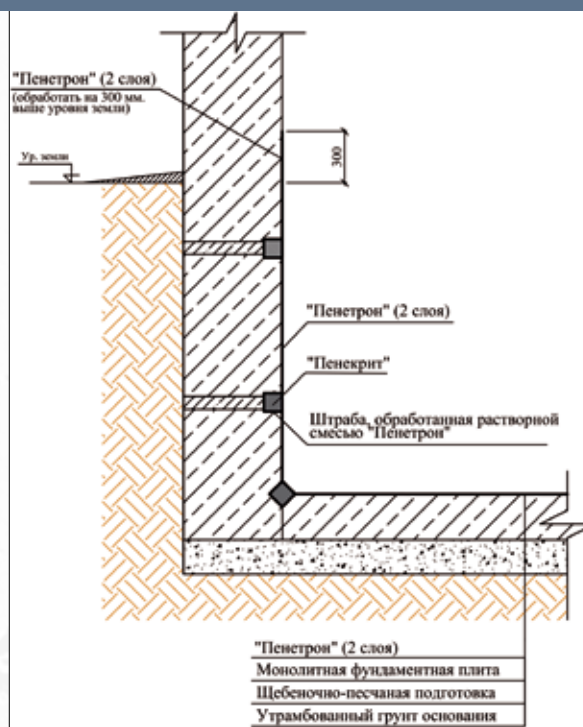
Гидроизоляция швов между фундаментными блоками
